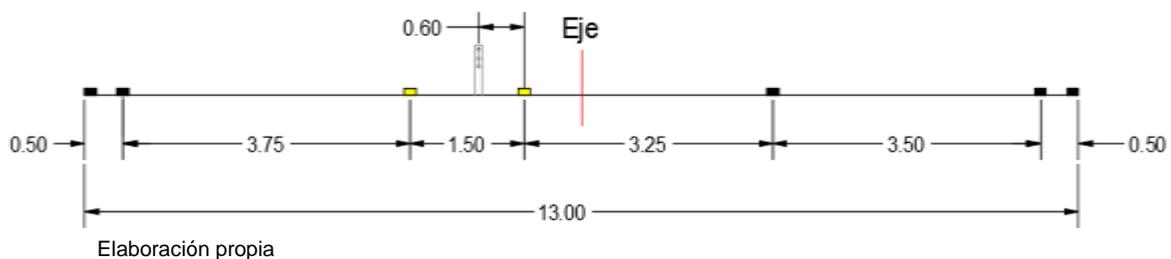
Sección transversal propuesta para carreteras 2+1
